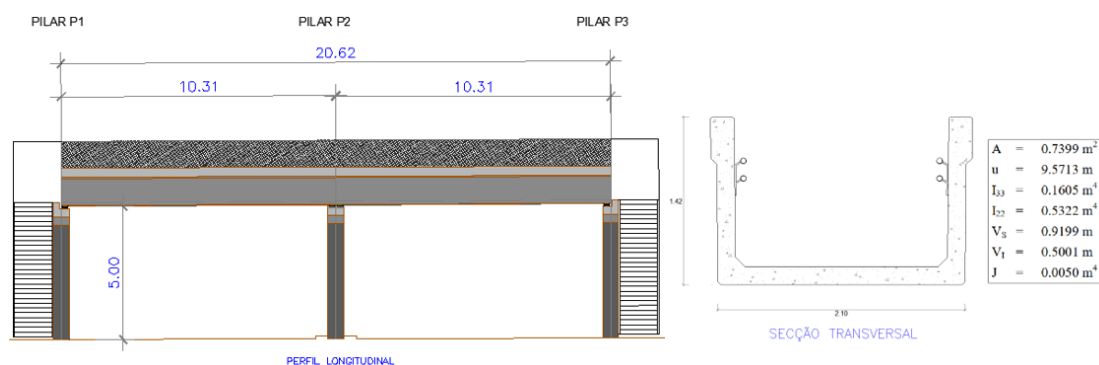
Perfil longitudinal da passagem superior e secção transversal
